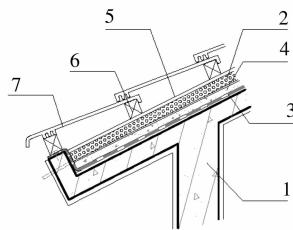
块瓦坡屋面泡沫玻璃板保温示意图
